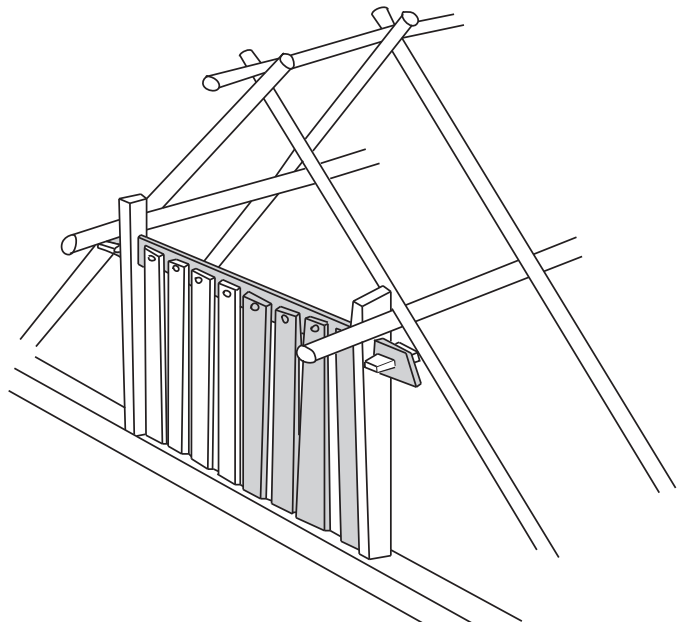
Reconstructietekening van de koppelbalk met planken beschot in een kapconstructie.
